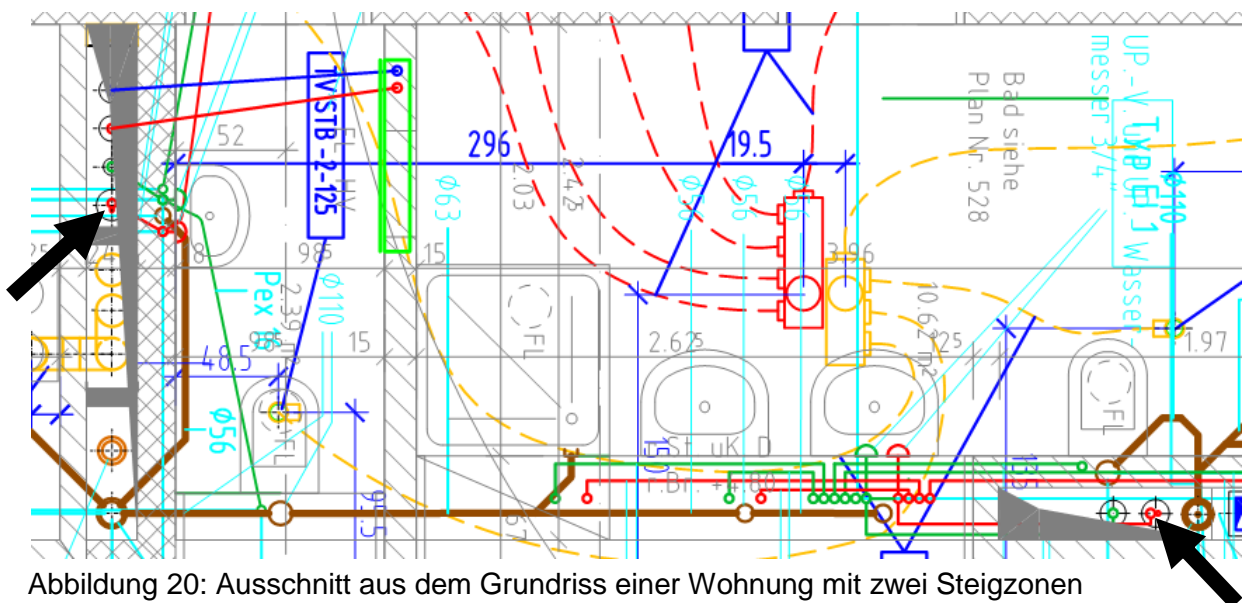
Ausschnitt aus dem Grundriss einer Wohnung mit zwei Steigzonen
